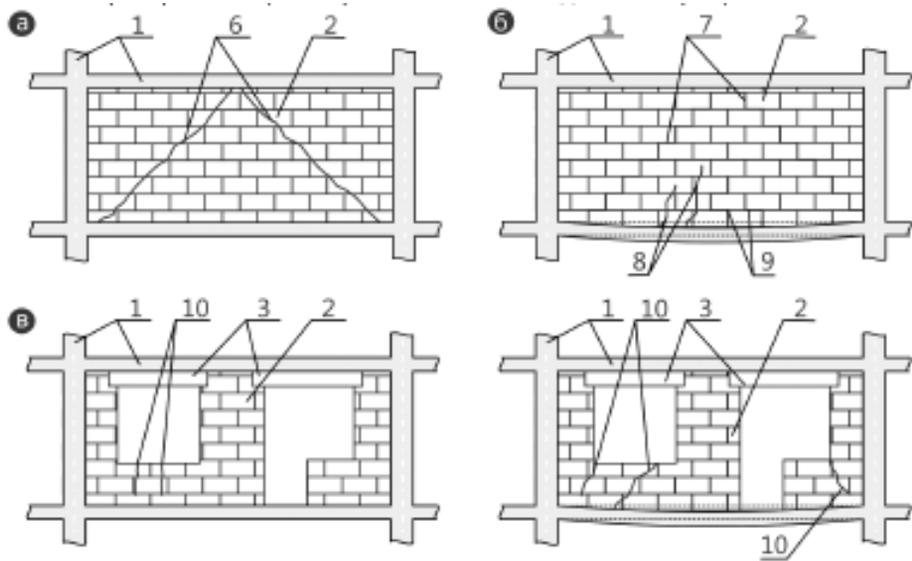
Характер повреждения кладки наружных стен на глухом участке и с проемами при прогибе края верхнего или обоих дисков перекрытия
